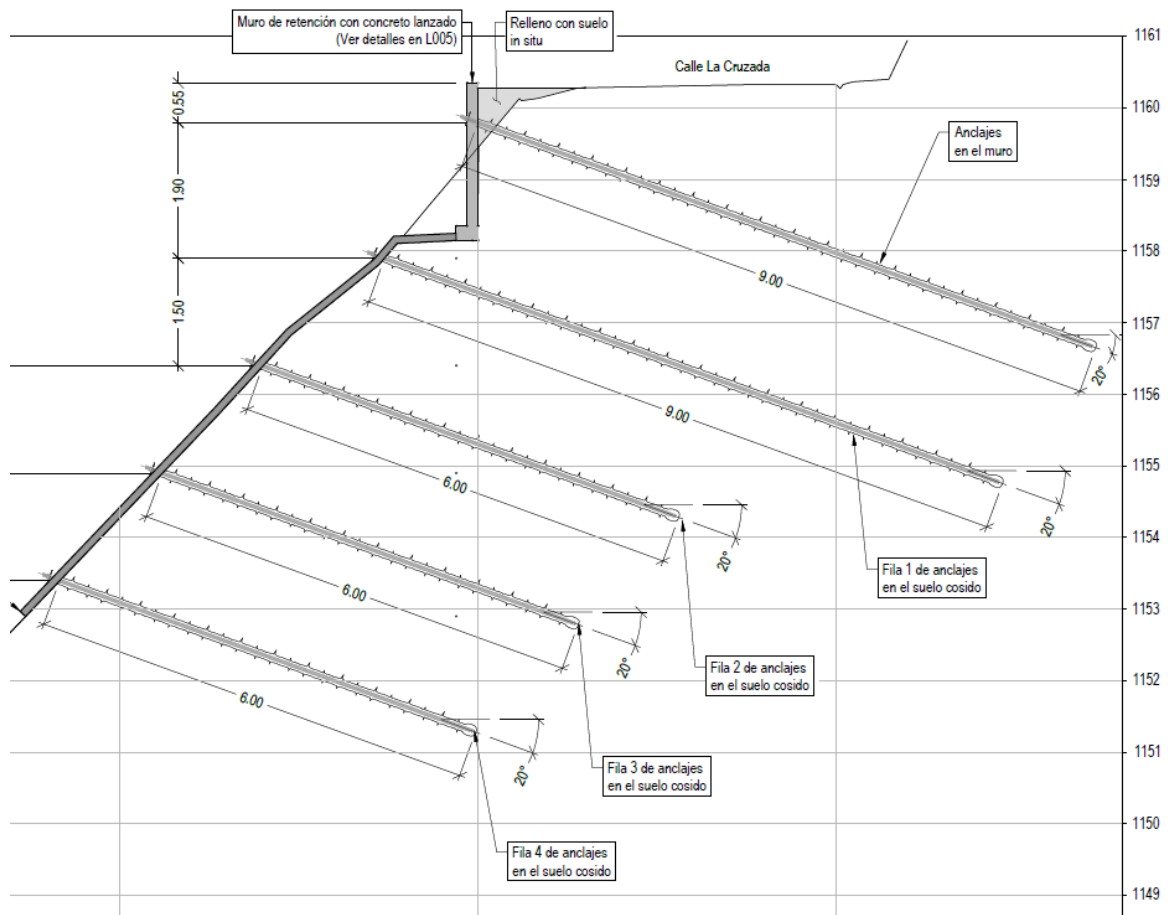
Perfil de obras de estabilización en calle La Cruzada, Salitral, Santa Ana.
